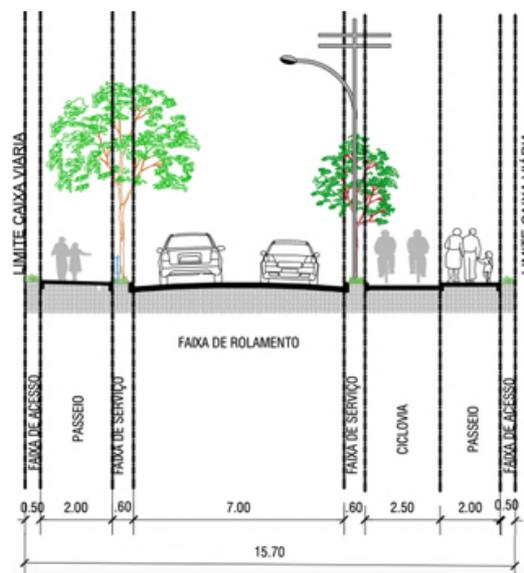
Via de Circulação de Vizinhança 1 – Rua Travessa 01. Fonte: MDE EP
